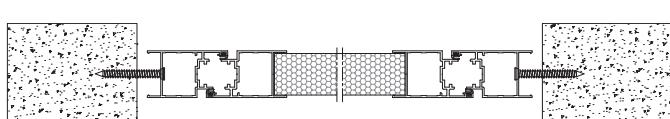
Montaggio su muro - telaio standard - sezione orizzontale - porta a un'anta - sistema AW45.
